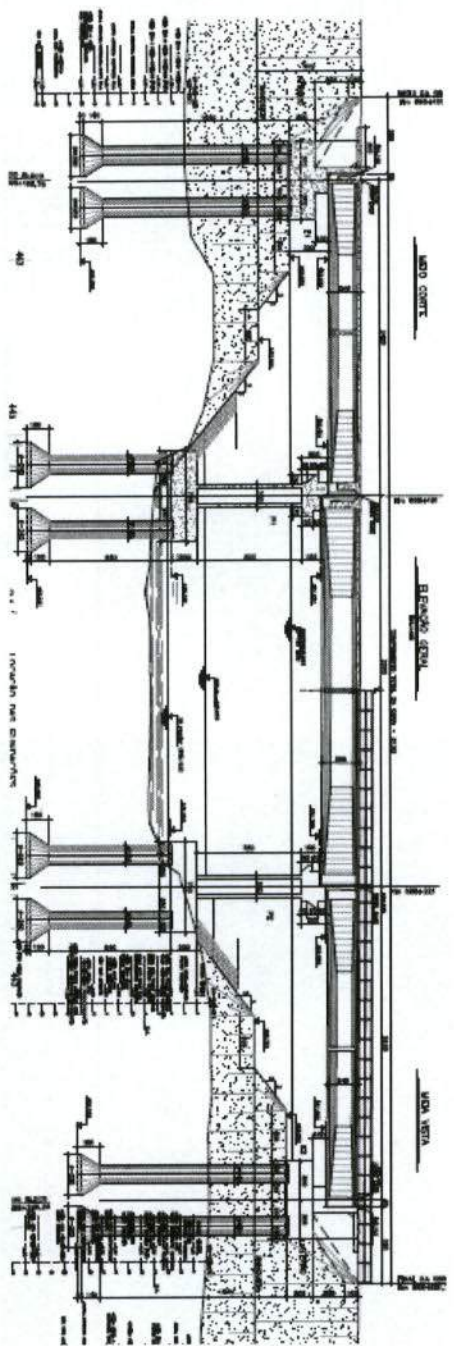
Projeto da ponte sobre o Rio Arrojado (elevação em corte)
